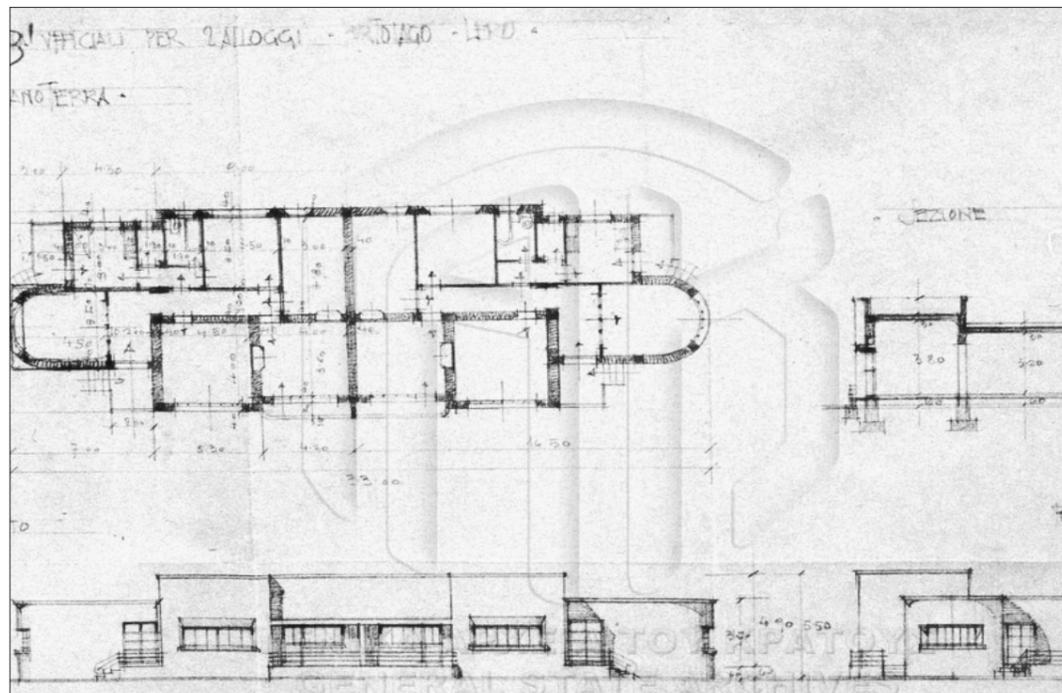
casa ufficiali B1, pianta prospetto e sezione, sc. 1:100
